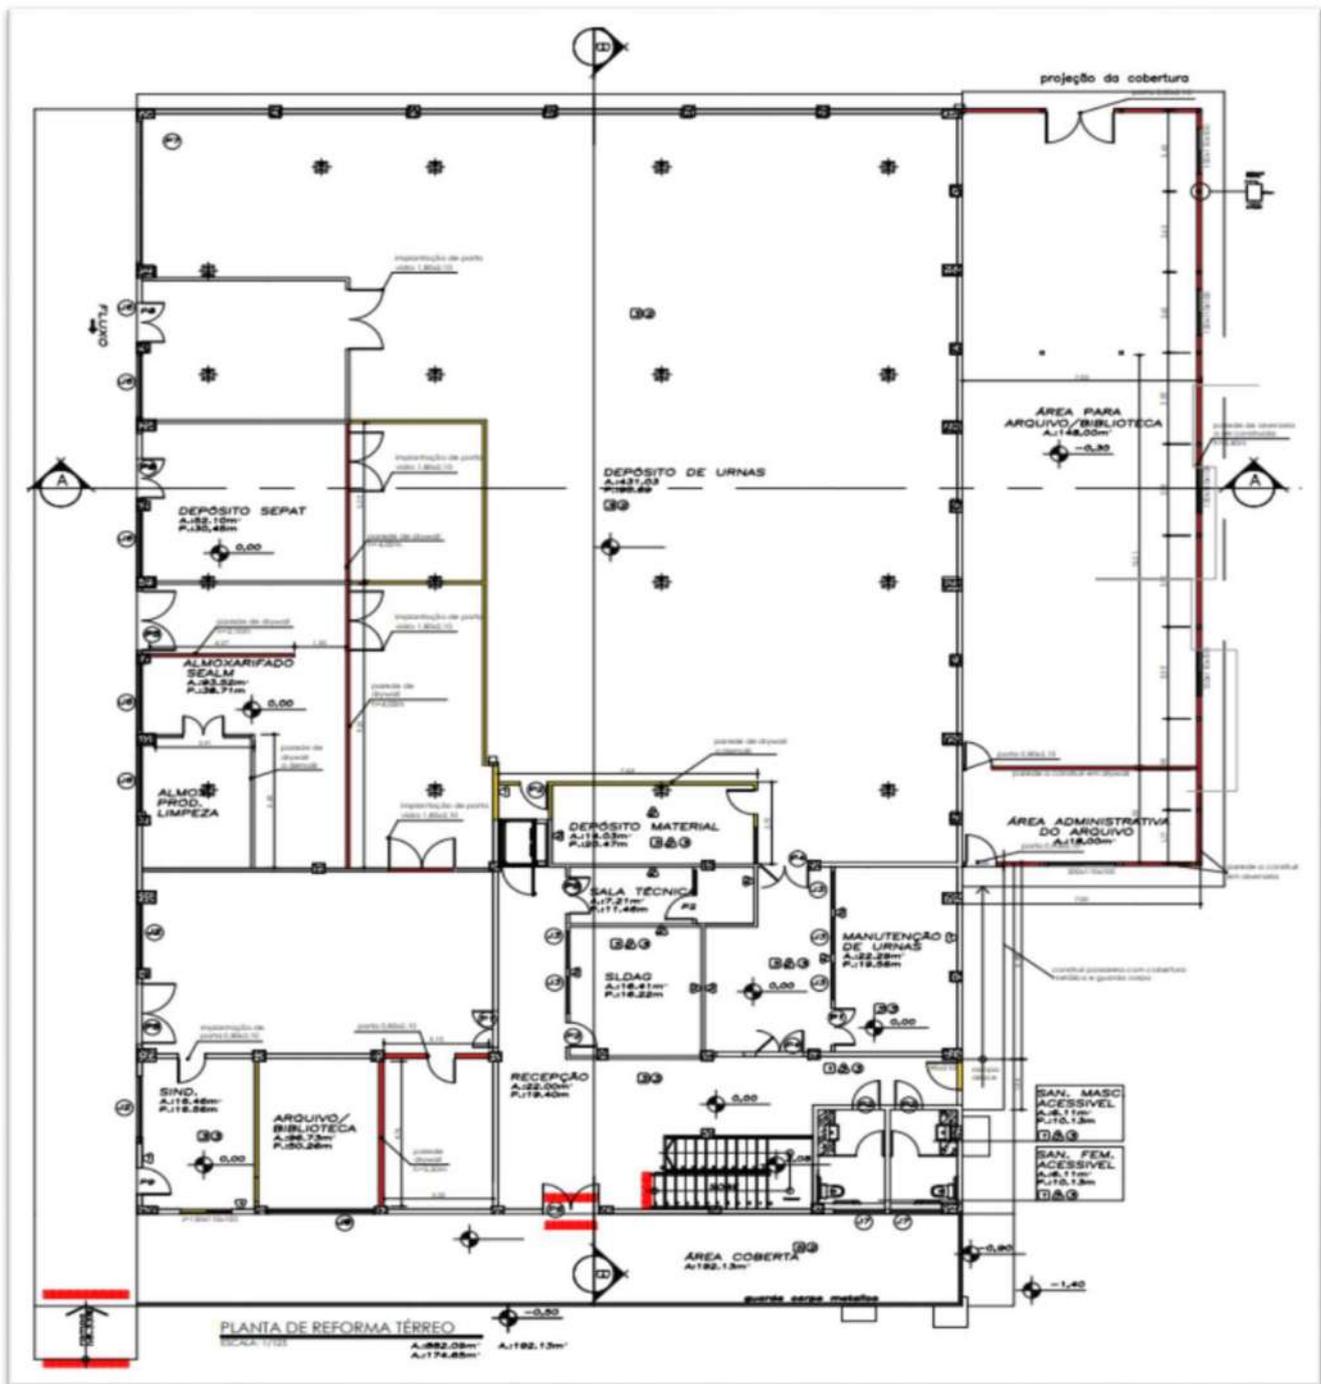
Planta baixa DUE – Pavimento Térreo
